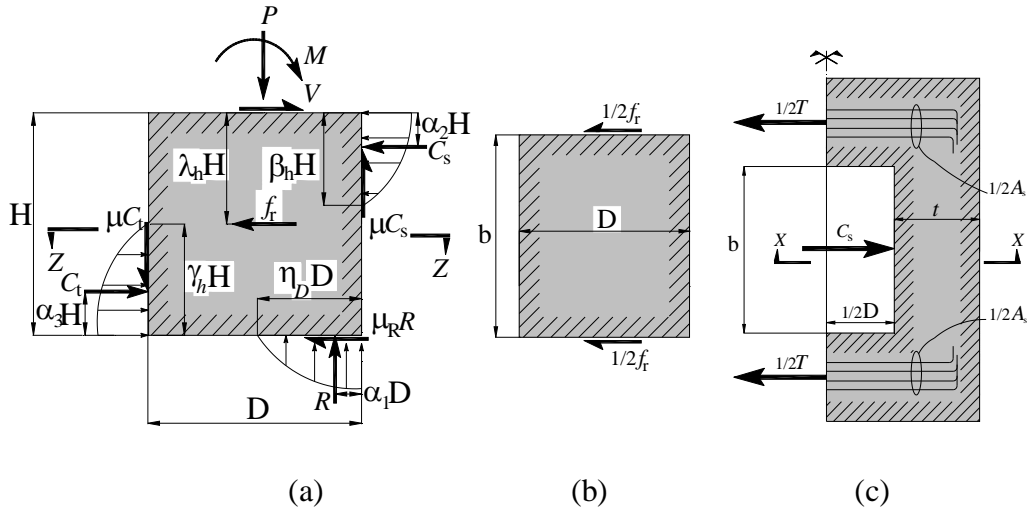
Fuerzas en la cimentación candelero sin presfuerzo. a) Reacciones en columna dentro de candelero, elevación, b) Corte Z-Z, c) Planta
